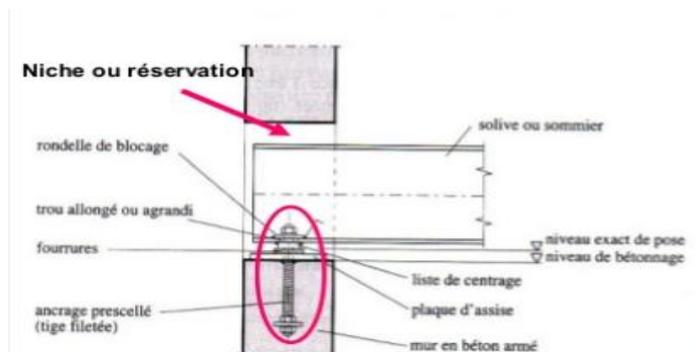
^{xxii}: assemblage poutre mur en béton armé(f)
